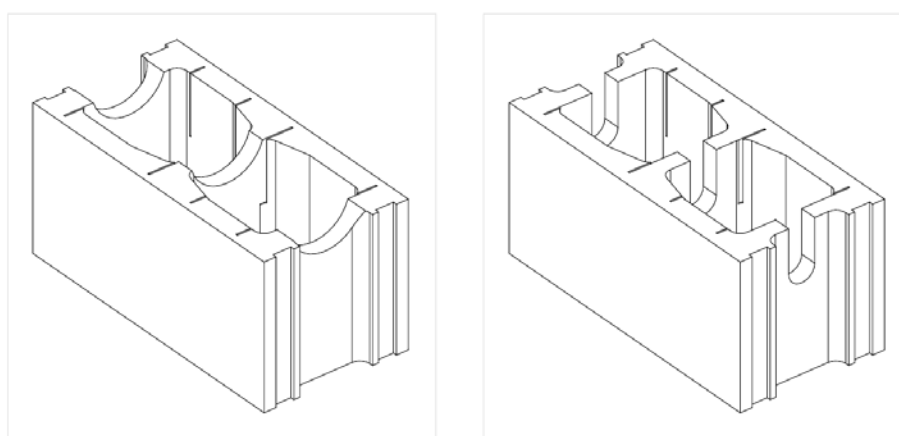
Comparación entre la pieza previa con rebajes en horizontal y modificada con rebajes en vertical.
